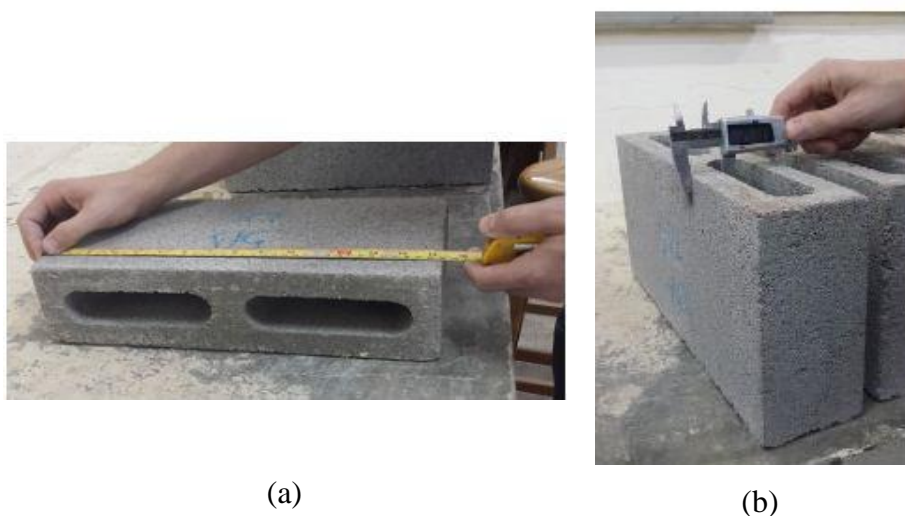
Realização do ensaio de análise dimensional dos blocos de concreto com auxílio da trena metálica (a) e do paquímetro (b).
